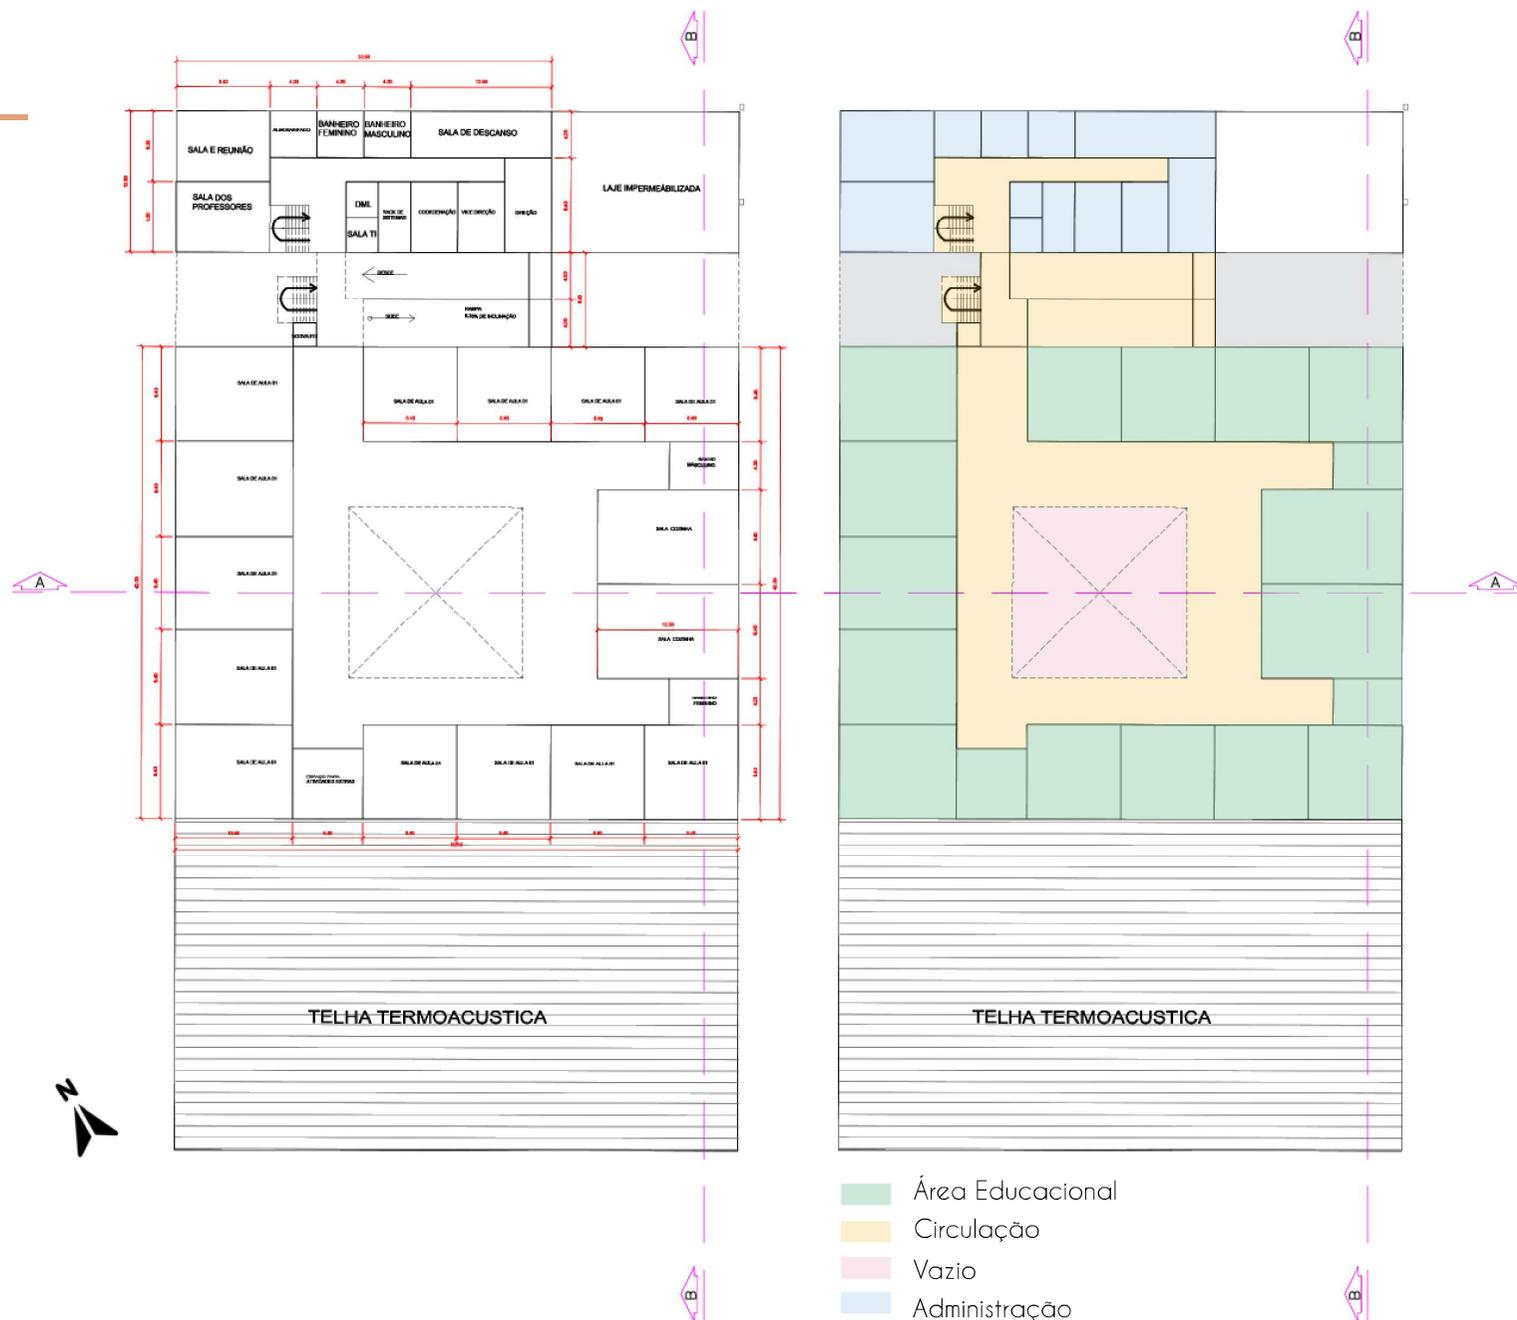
Planta do 1 pavimento- Fonte: Desenvolvido pela autora
